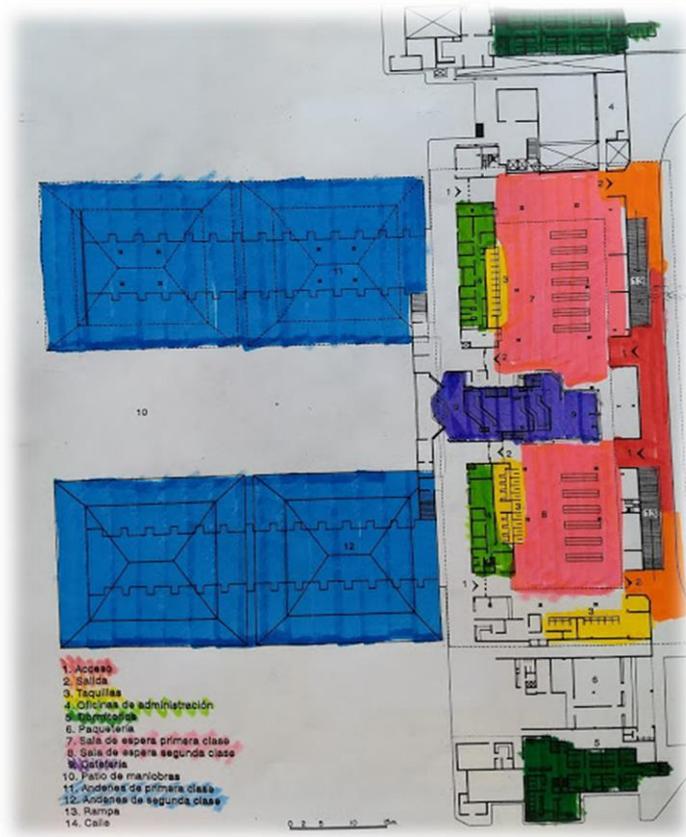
PLANTA DEL EDIFICIO TERMINAL
